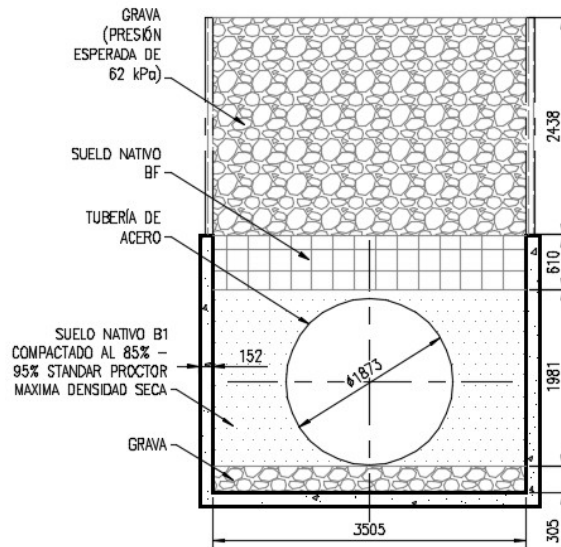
Sección de la instalación para la Prueba 1a (En mm). Adaptado de (SHARMA, 2013).
